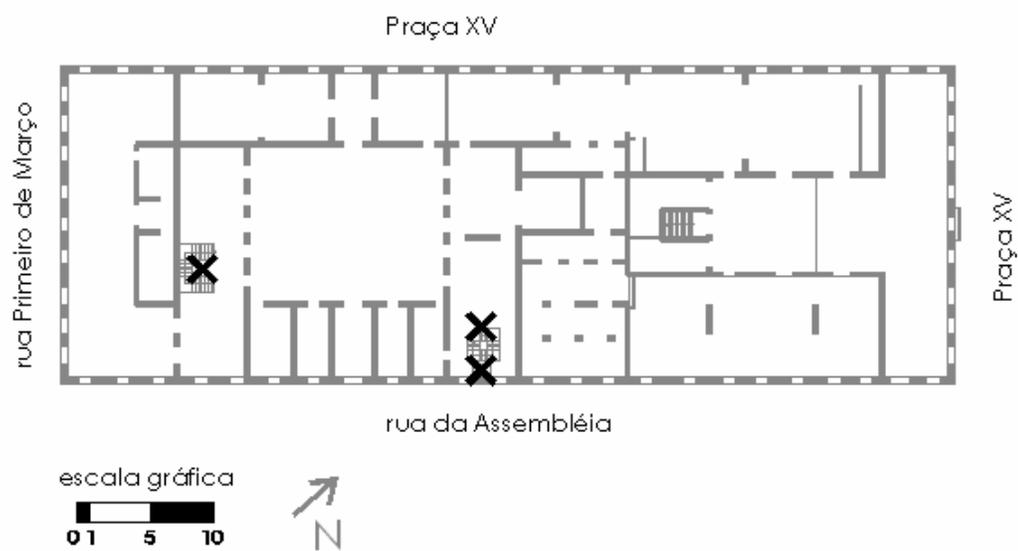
Paço Imperial - Planta do pavimento térreo.
